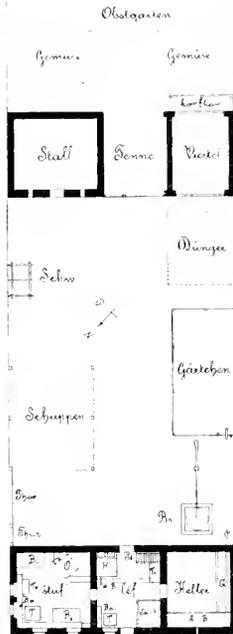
Plan des Hauses Nr. 125 in Wallendorf.
